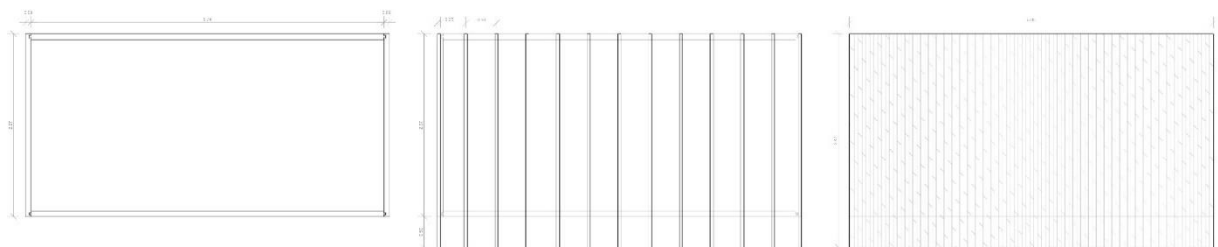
Plantas constructivas de cubierta. Fuente. Elaboración propia.
